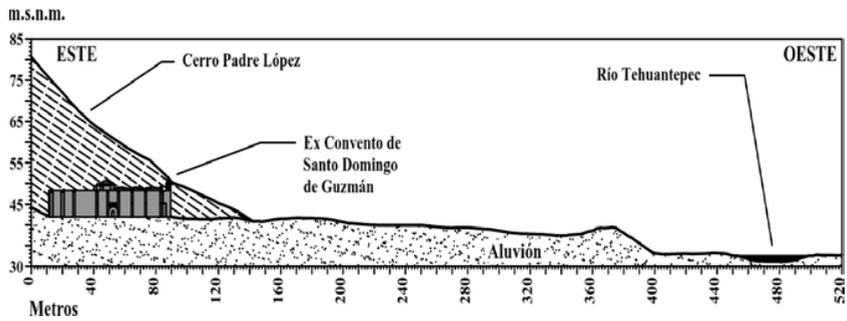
Croquis de alzado a escala de la fachada norte del conjunto exconventual y perfil del terreno; escala horizontal del terreno: 1:1 m, escala vertical del terreno: 1:2 m. Elaboración de Iván Salazar y Raúl A. Mena.
